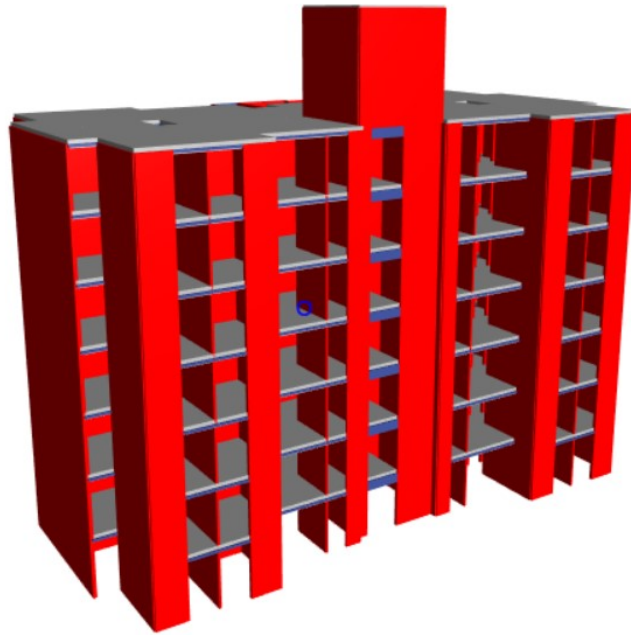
Modelamiento Superestructura Sistema MDL – Edificio Blesser. Vista 3D. Fuente: Elaboración Propia.
